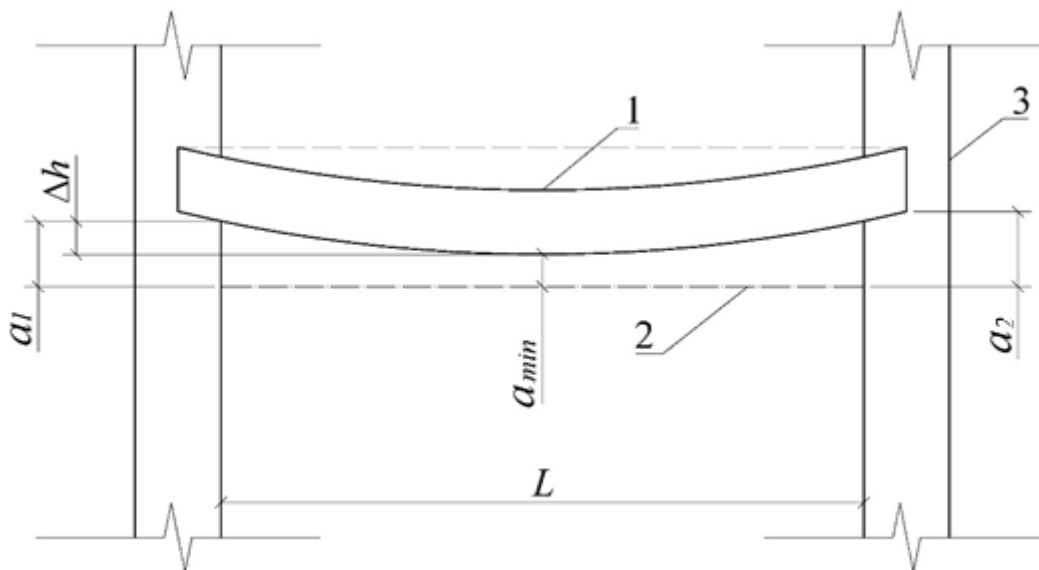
Схема измерения прогиба плиты перекрытия:
